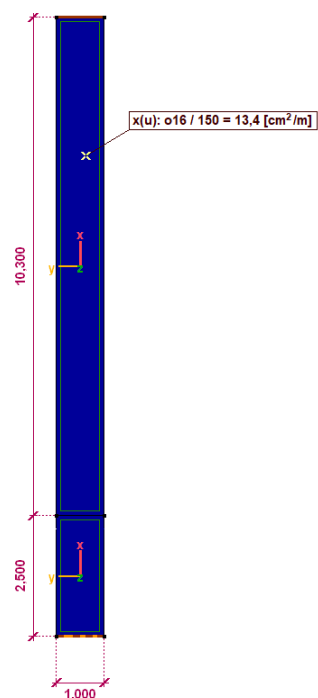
Innere Wand, mittlere Zone, gewählte Bewehrung vertikal (links und rechts)
